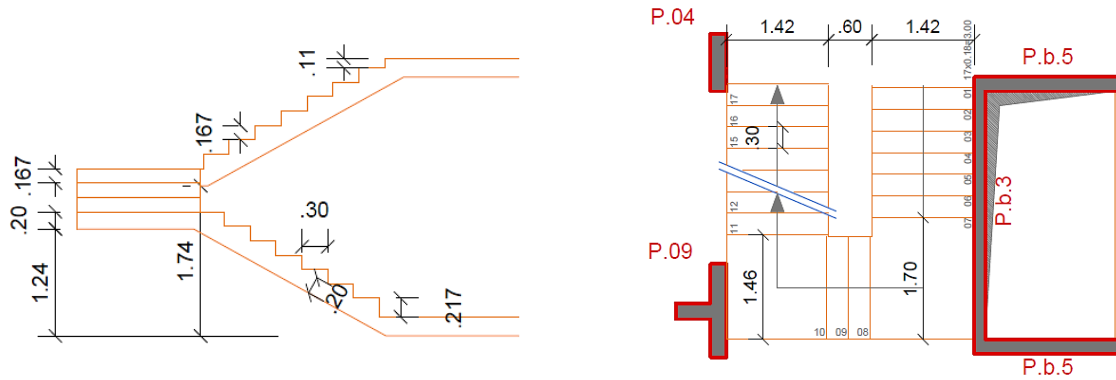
Planta e corte da escada do lote 6.7, piso 0 ao 8.
